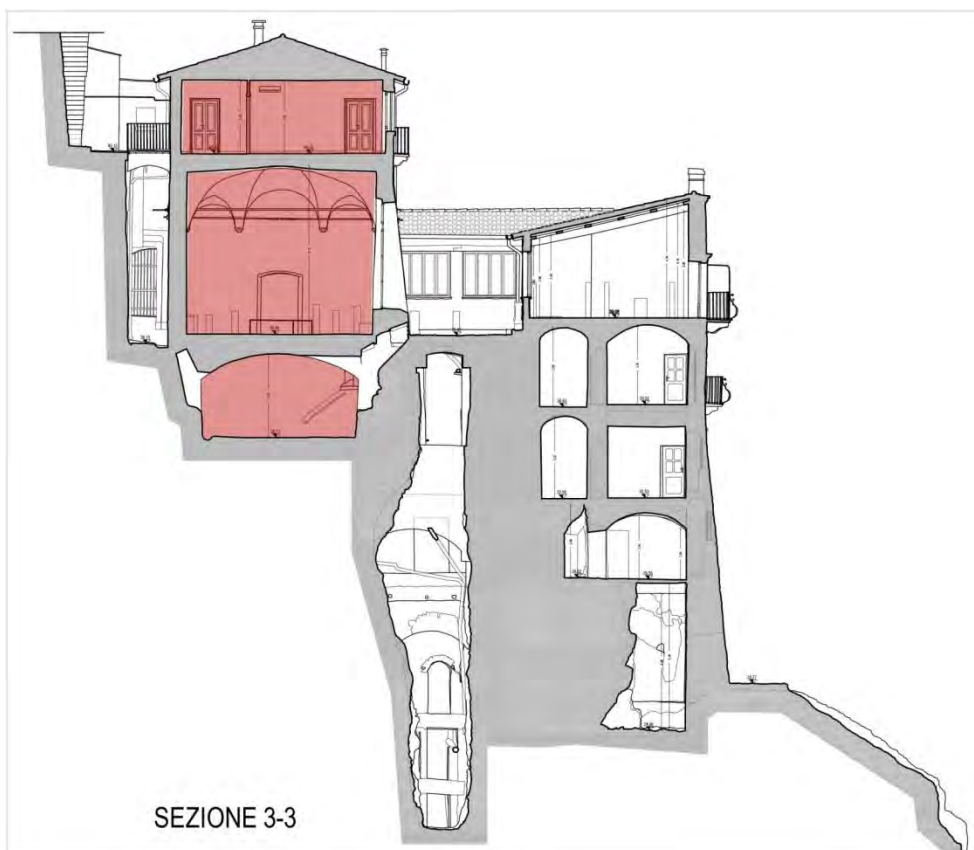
4 - sezione 3-3, individuazione U.S.
